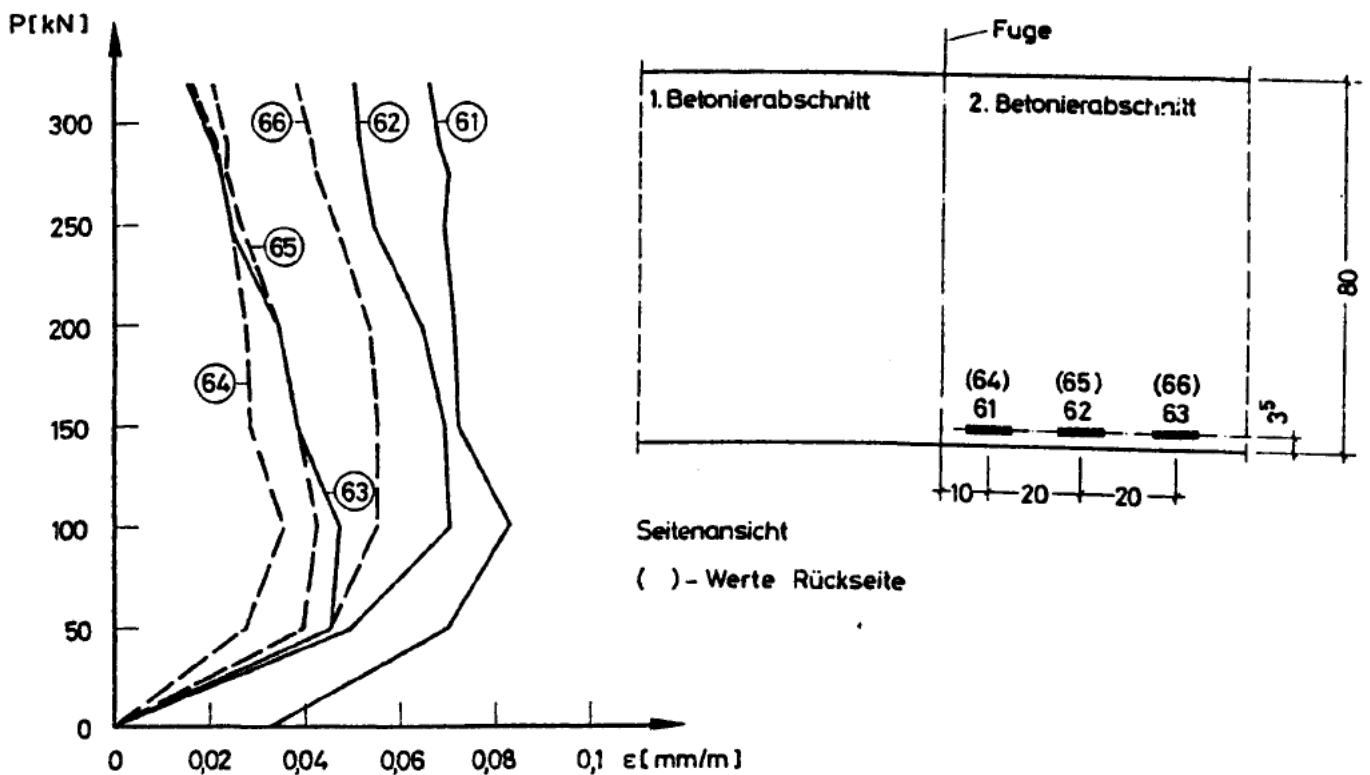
Dehnungsmessung in der Betonzugzone, Balken 13 (PZ)
